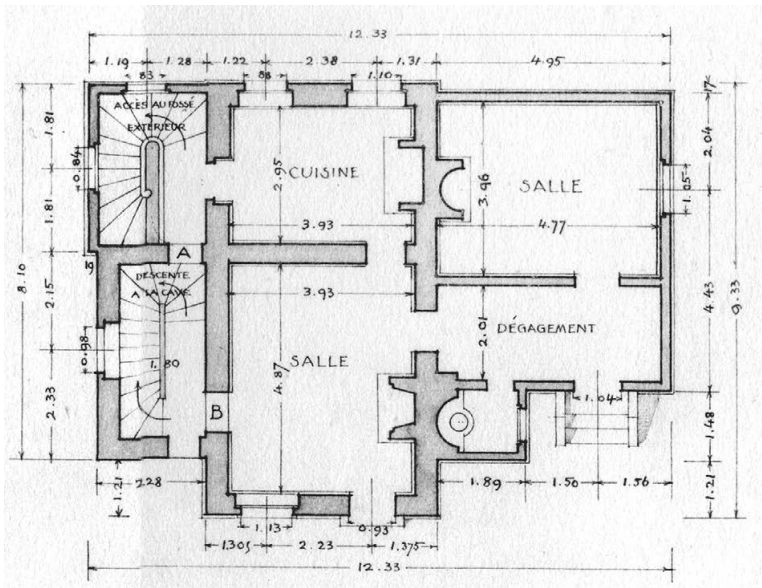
Hameau de la Reine, Maison du Garde*, Grundriss, aus: Georges Gromort: *Le Hameau de Trianon*, Paris 1928, Abb. 40
